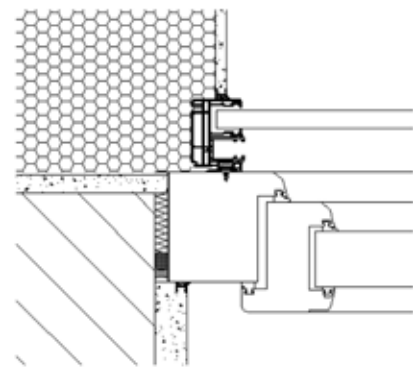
Anschlussdetail mit Führungsschiene AK-FLEX
